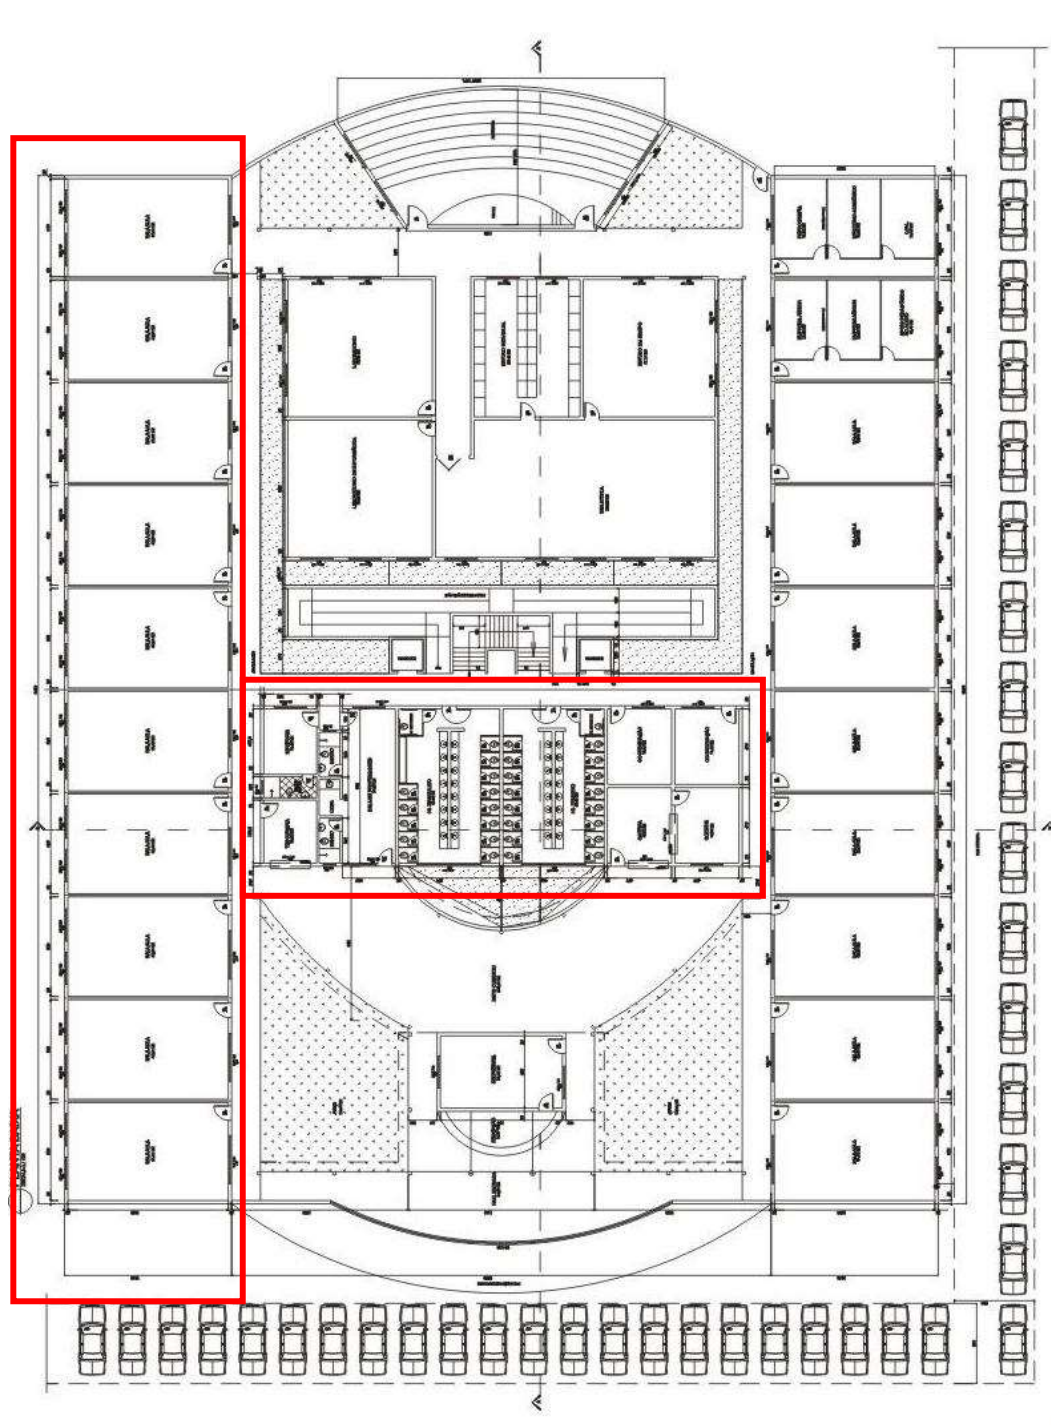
Projeto Arquitetônico – 1º Piso – Construção da sede – área construída
